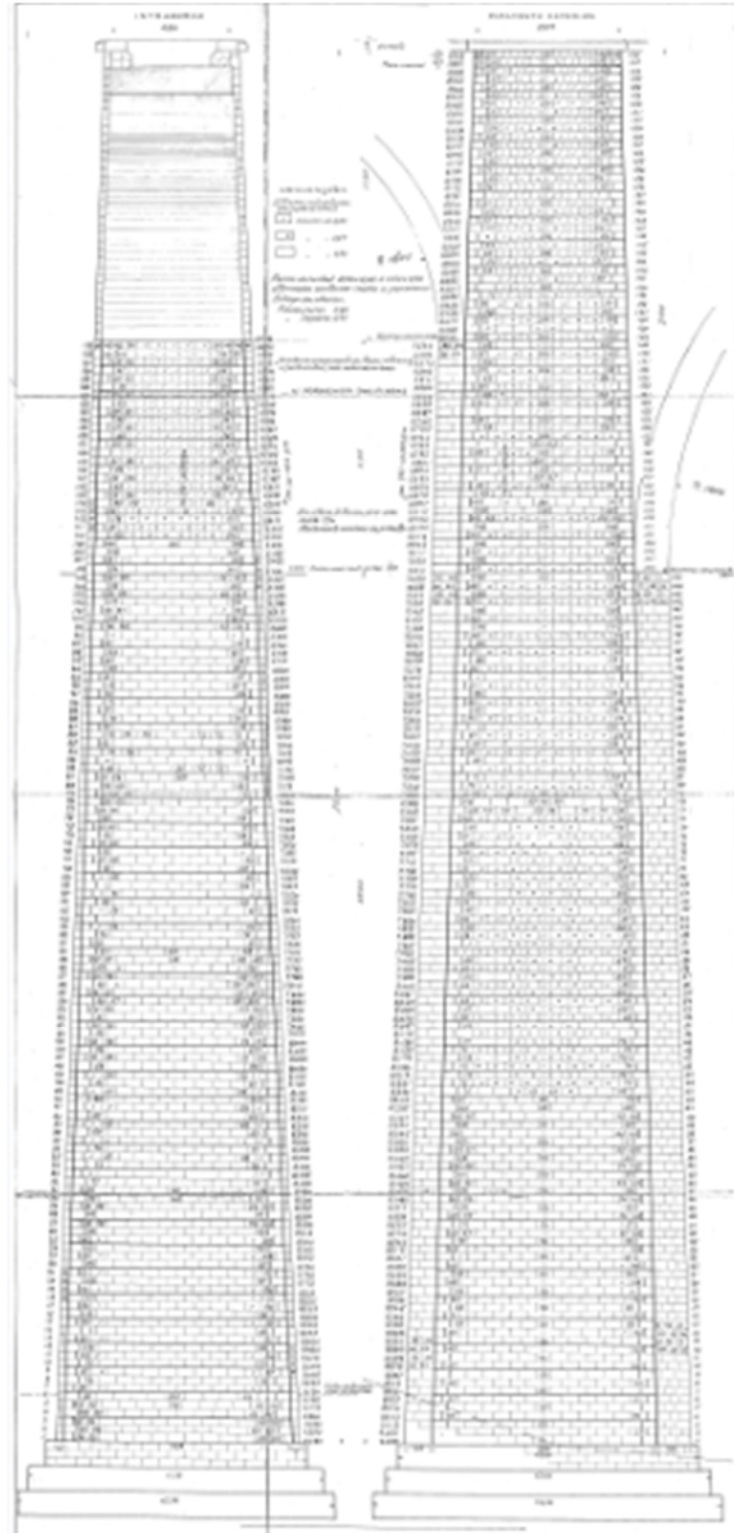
Pormenorização da alvenaria de paramento do pilar P4 (REFER, 1944)
